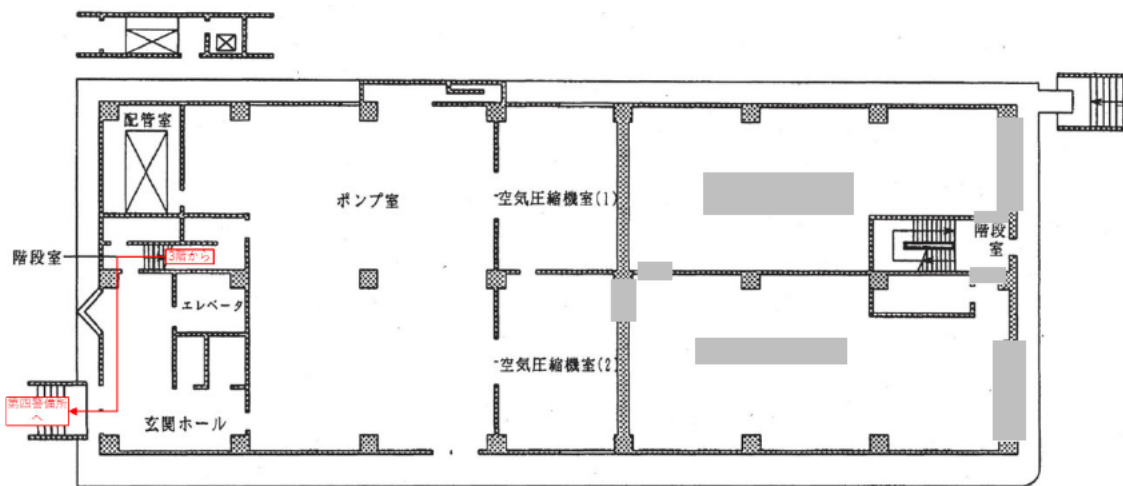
(2) 移動経路 (ユーティリティ施設 地上1F 平面図)
